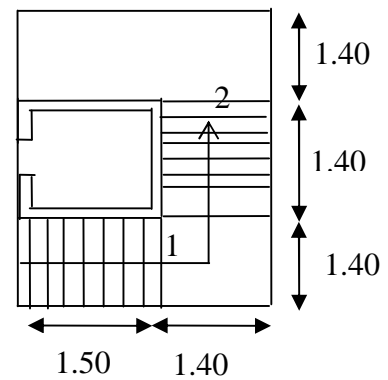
Vue en plan de l'escalier d'entresol
